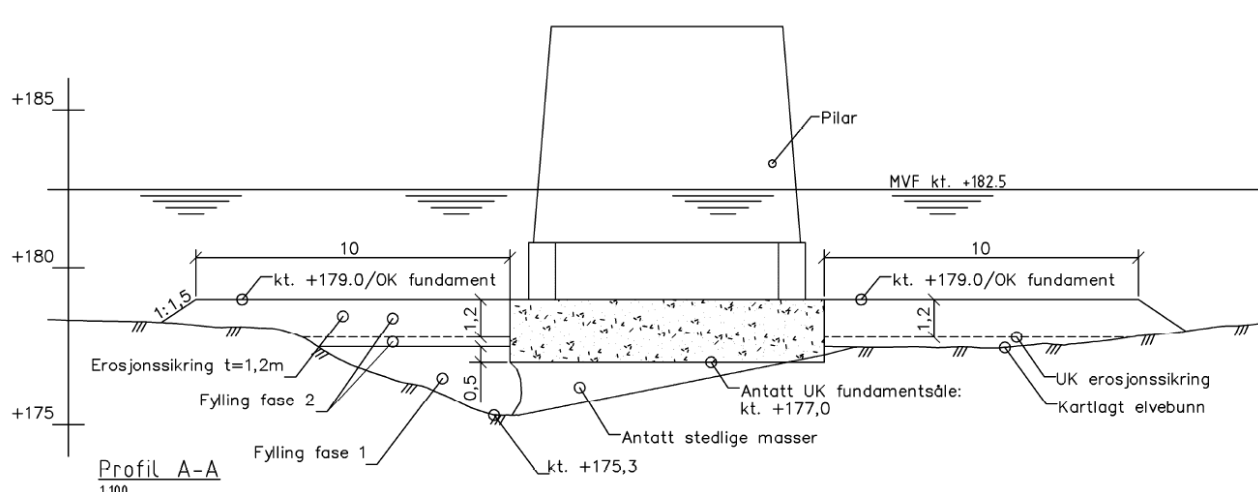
Innmålinger av utvasking rundt fundament [3]
